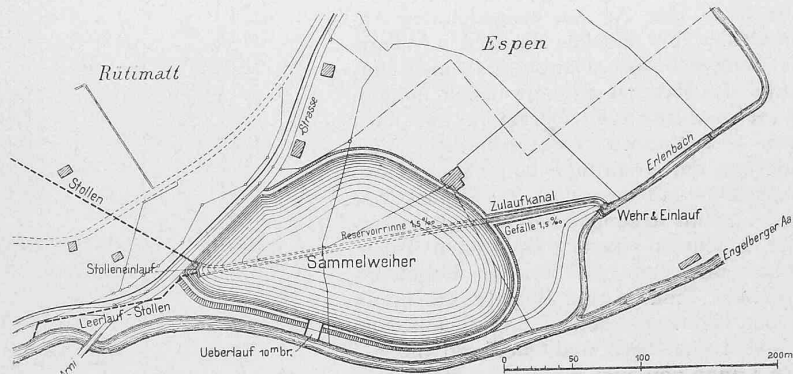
Lageplan des Sammelweihers. — Masstab 1 : 5 000.
